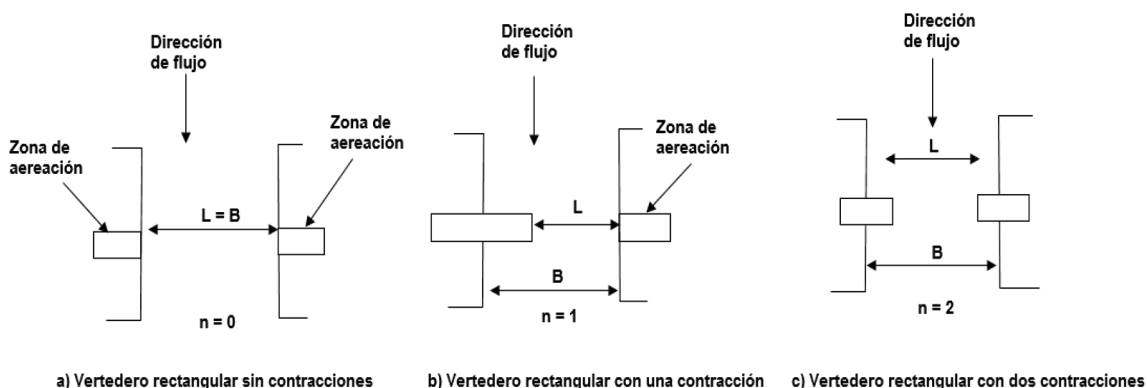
Vista de planta de tres tipos de vertederos rectangulares
